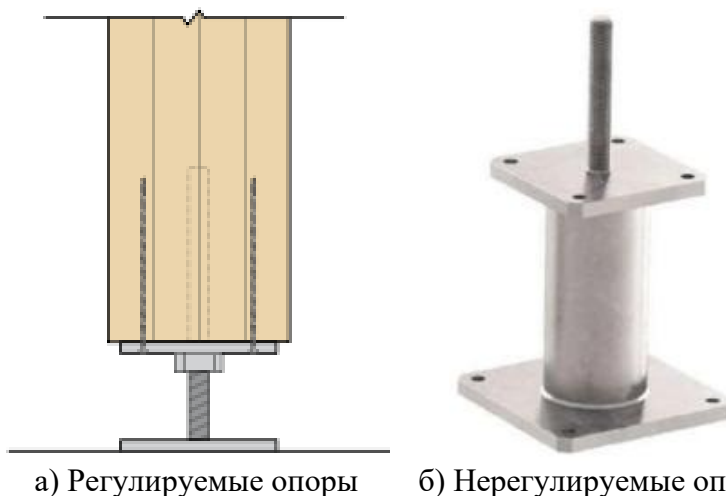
Узел крепления деревянной колонны к фундаменту на металлических коннекторах¹
